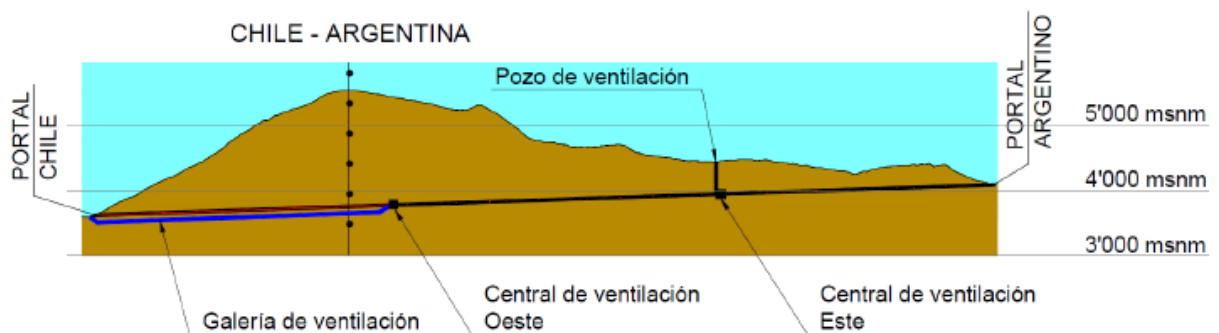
Perfil longitudinal general de las obras civiles del TAN
